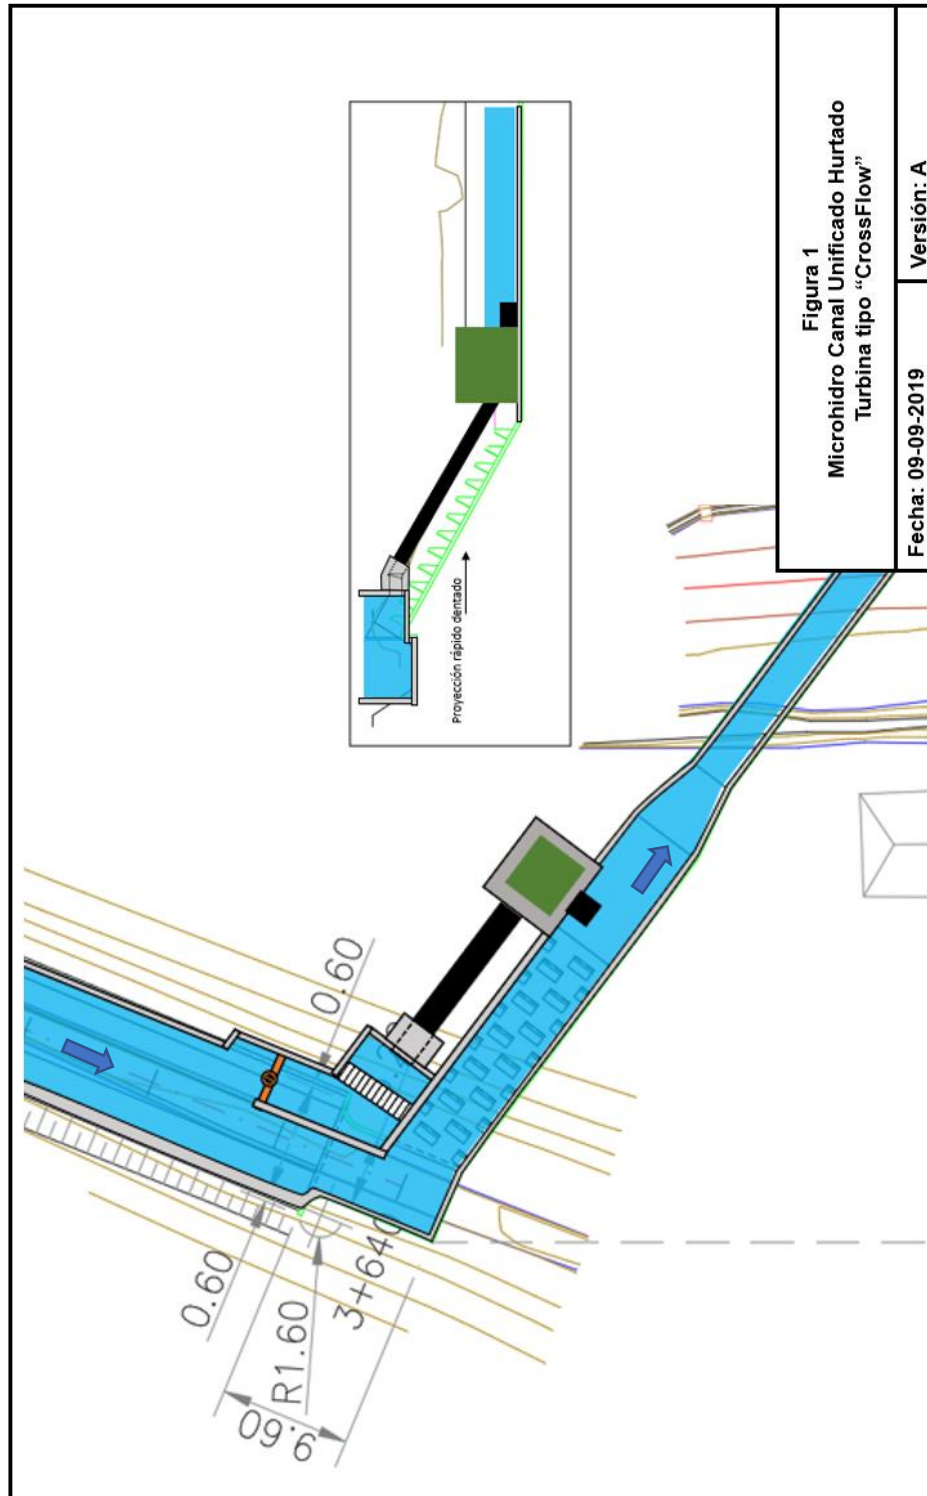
Esquema de implantación de una central de generación tipo "CrossFlow"; vista en planta y elevación
